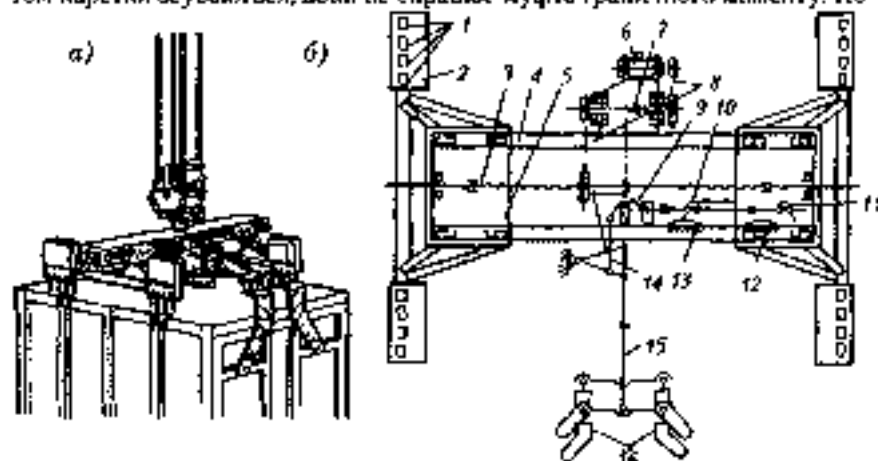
Автостроп: а — загальний вигляд; б — принципова схема; 1 — гачкова гребінка; 2 — механізм захвату; 3 — ходовий гвинт; 4 — рама; 5 — каретка; 6 — електродвигун; 7 — муфта граничного моменту; 8 — двоступенева ланцюгова передача; 9 — верхній звольічний важіль; 10 — лівий храповий механізм; 11 — правий храповий механізм; 12 і 13 — права і ліва зубчаті рейки; 14 — нижній звольічний важіль; 15 — рухома штанга; 16 — спрямовуючі козирки.
